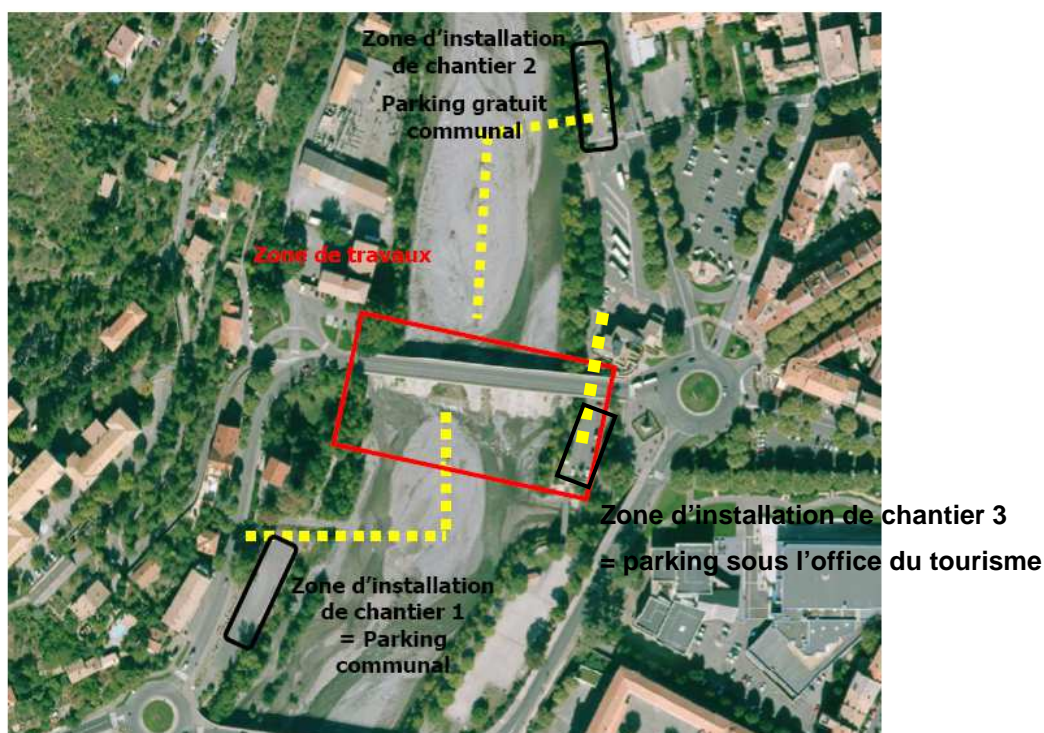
Accès et installation de chantier pour les travaux du seuil du Grand Pont
